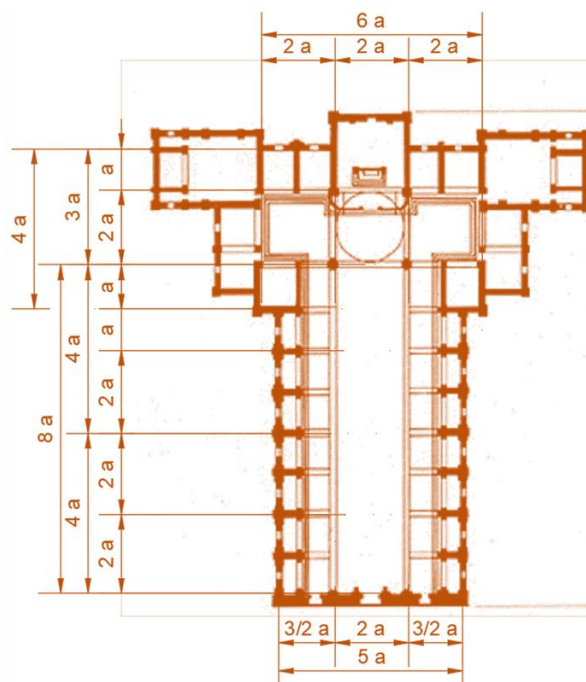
Proporciones en la planta de la Basílica de San Lorenzo.
